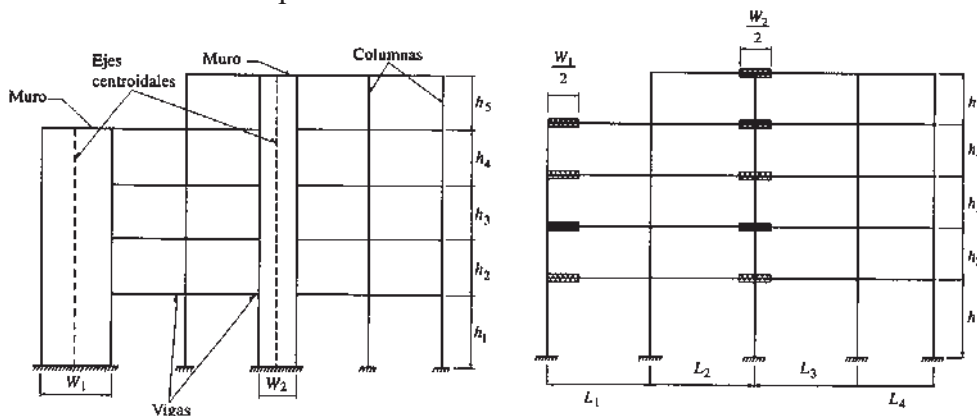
Sistema muro-marco idealizado con columnas anchas
